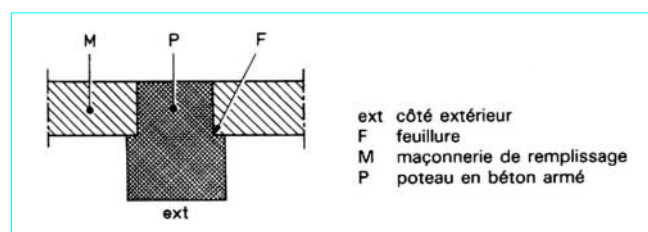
Poteau avec feuillure en saillie par rapport à la maçonnerie
